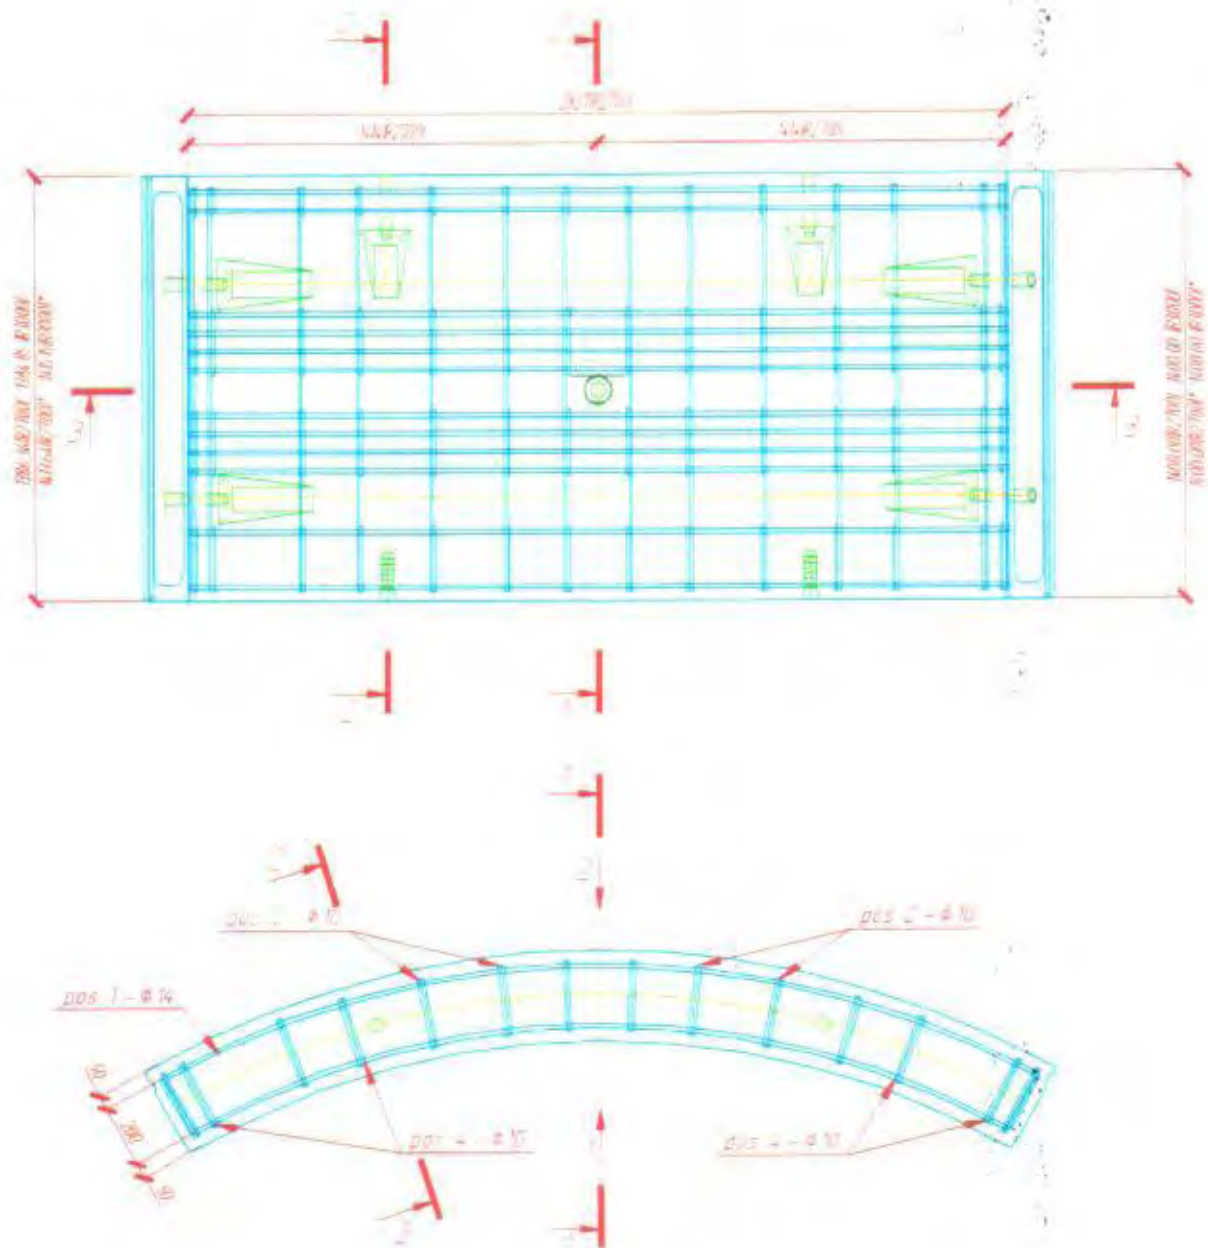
Принципиальная схема армирования опытных образцов бетонного блока тоннельной обделки
